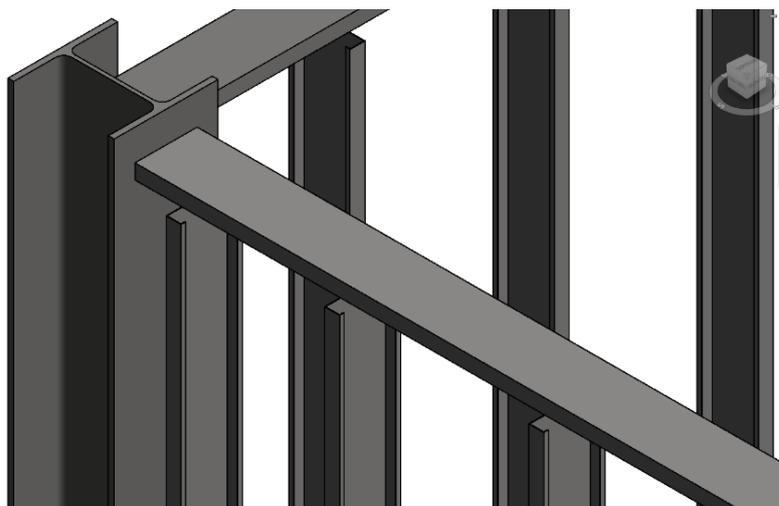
Pré Lançamento Steel Framing no Revit 2015 Detalhe
